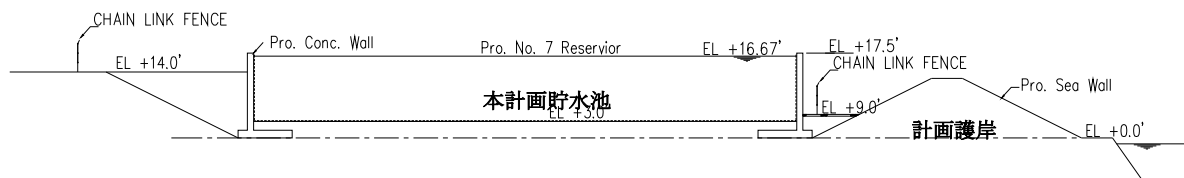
標準平面・断面図（案-1：土堤+逆 T 式擁壁形式）
